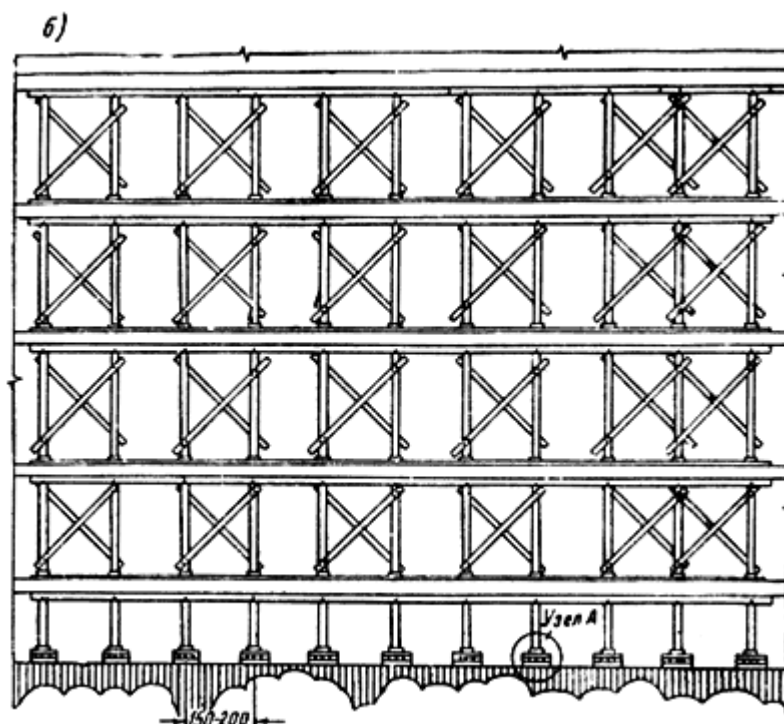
Установка временных креплений при перекладке участка средней продольной стены с сохранением существующих перекрытий
